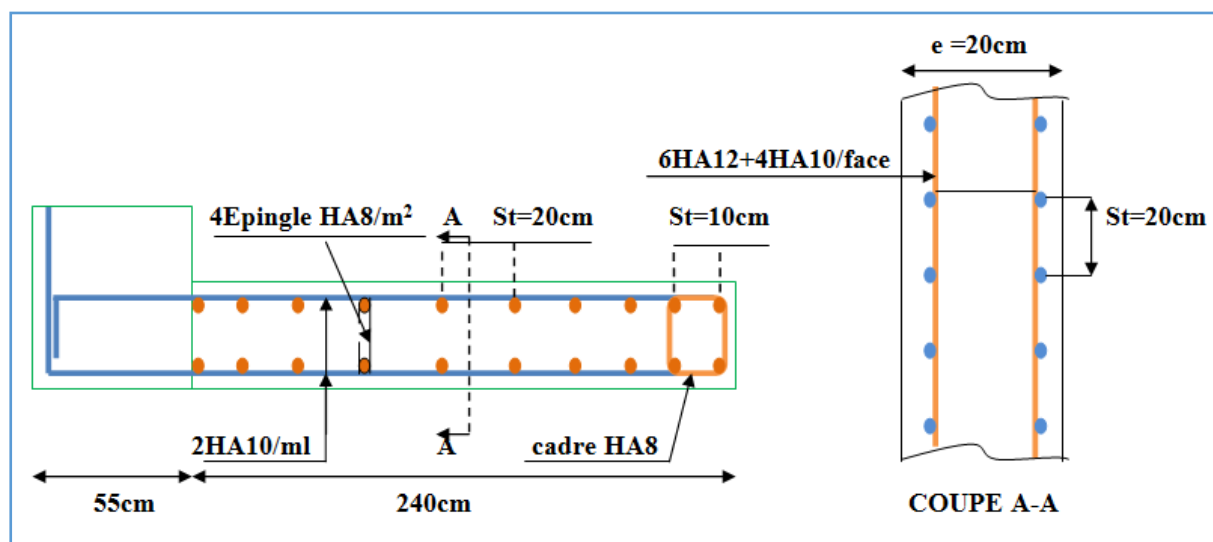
Exemple de ferrailage de voile RDC et étage 1 (Vx2)
